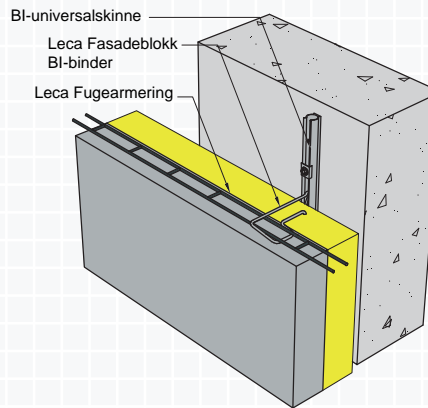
Oppløgg for Leca Fasadeblokk på betongkonsoll. Forblending mot eksisterende betongvegg.
